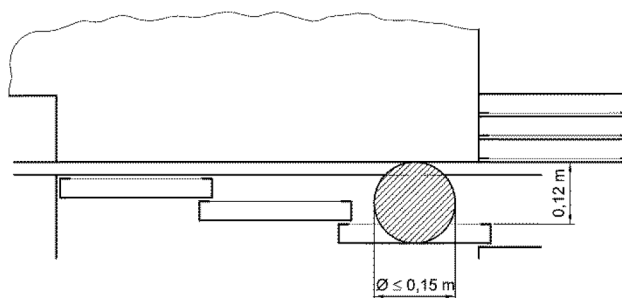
Porte palière et porte de cabine coulissant horizontalement, non couplées mécaniquement
